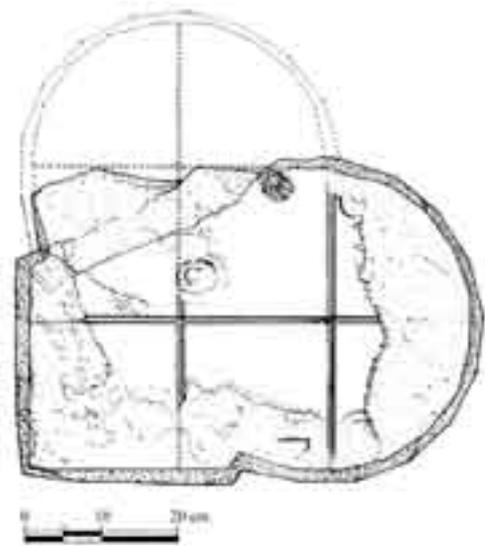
Palermo, cortile di Palazzo Sclafani. Pianta del letto di posa dell'elemento n. cat. 10 del pilastro angolare cuoriforme del secondo livello, con linee guida tracciate con pigmenti.
